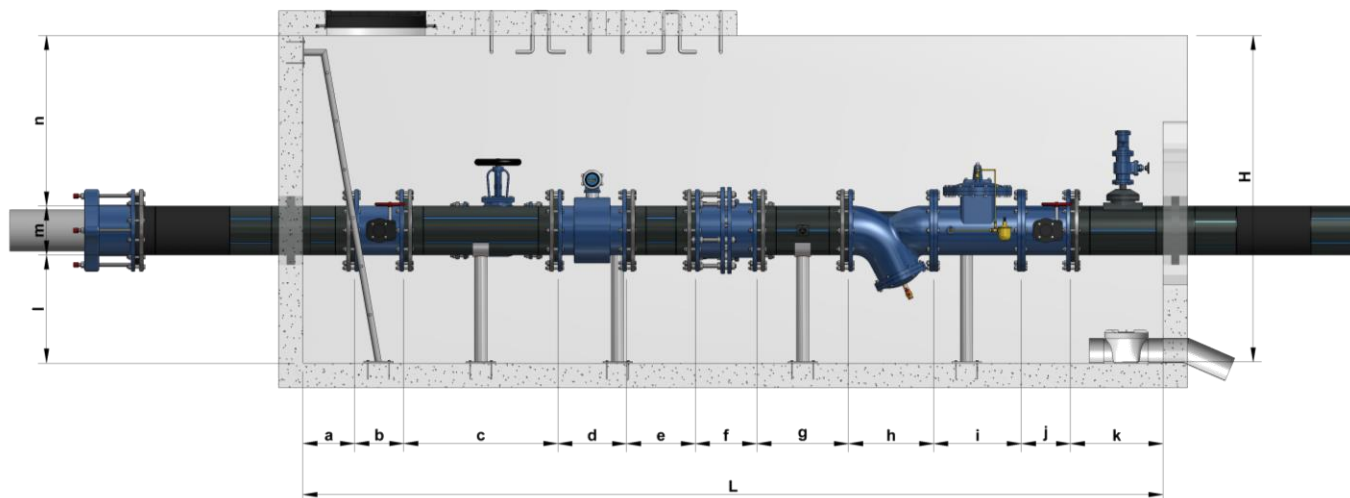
Disposición y ensamble de los componentes de la ERP - vista frontal en corte
